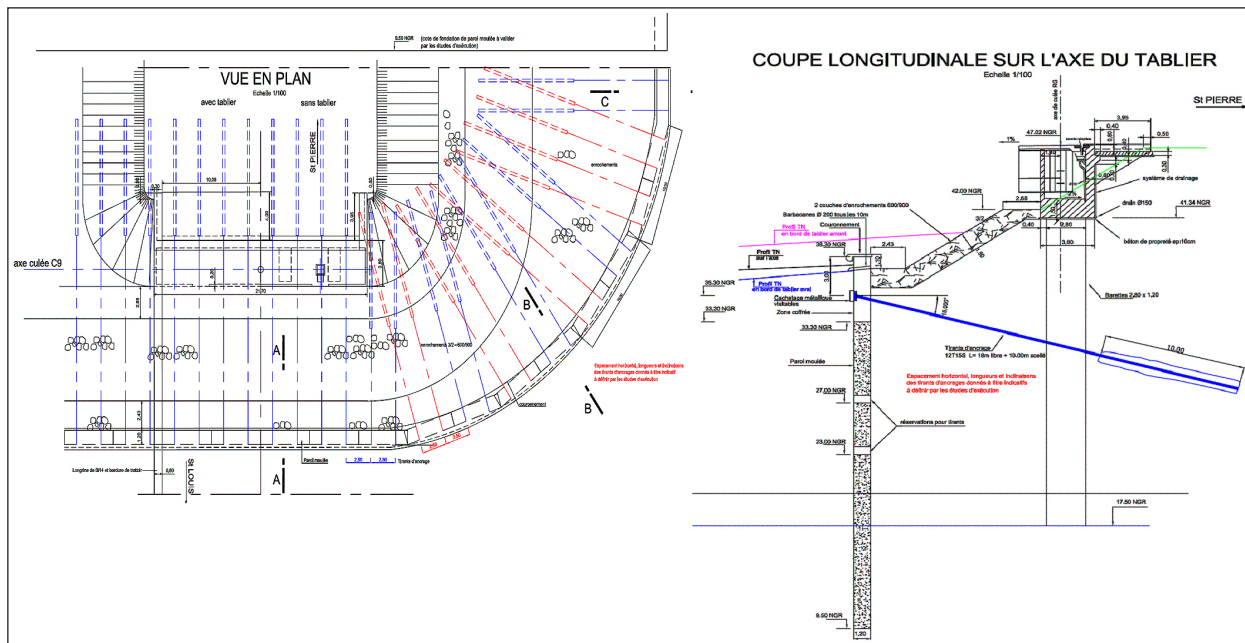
Vue en plan et coupe transversale de la culée et de sa protection
